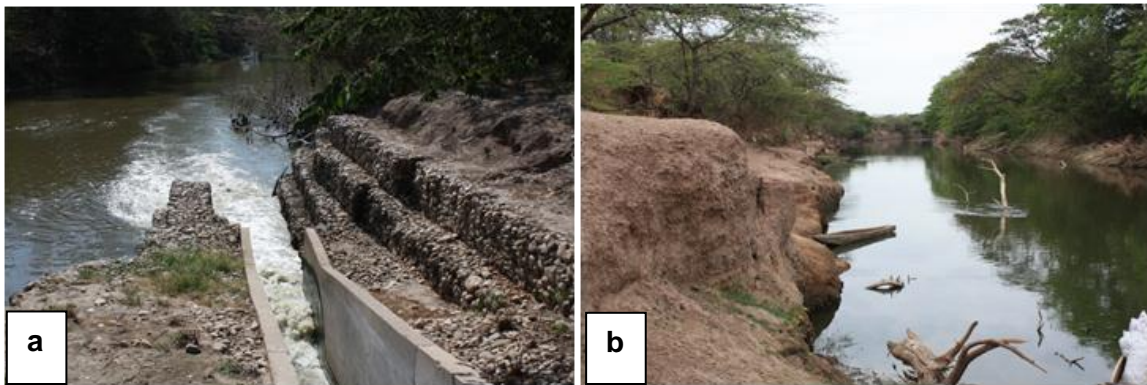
Imagen de las estaciones en Puente Salguero (a) y Las Pitillas (b).
